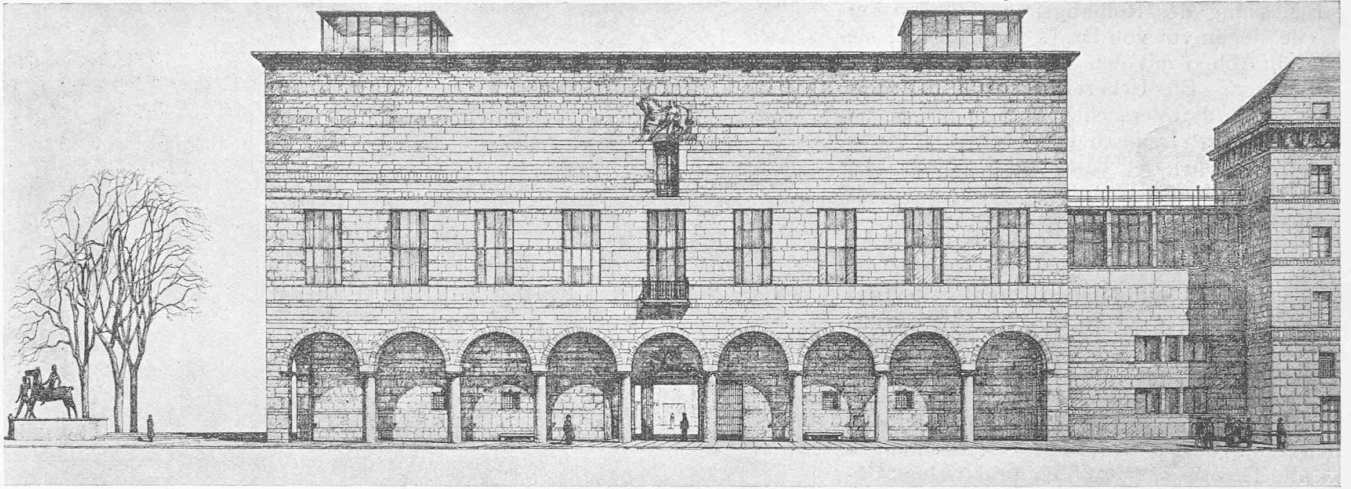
Hauptfassade am St. Albangraben, in Hausstein und mit betonter Mitte über dem Haupteingang. Rechts die Nationalbank. — Masstab 1 : 400.
